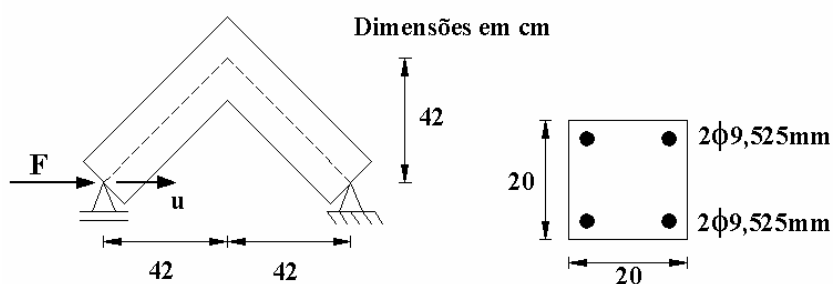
Geometria e armação do pórtico de Cipollina & Flórez-López
